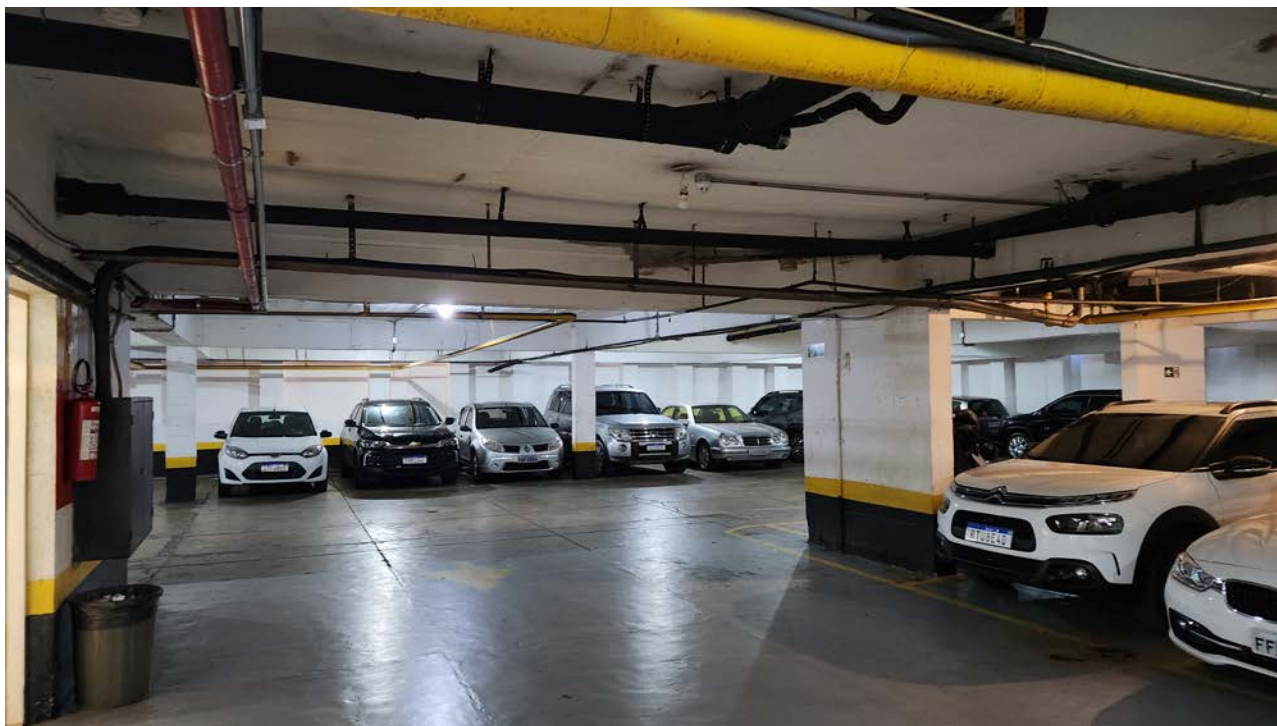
VISTA DAS GARAGENS DO 1º SUBSOLO.
